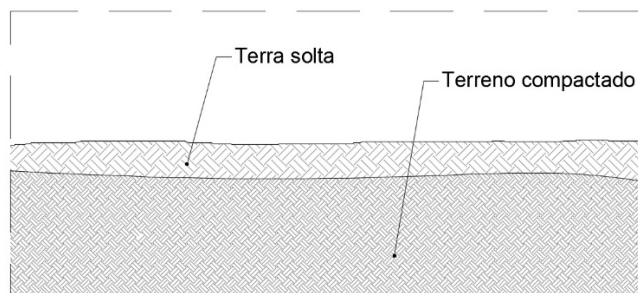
Pormenor do pavimento em terra natural (s/escala) – (Autor)
